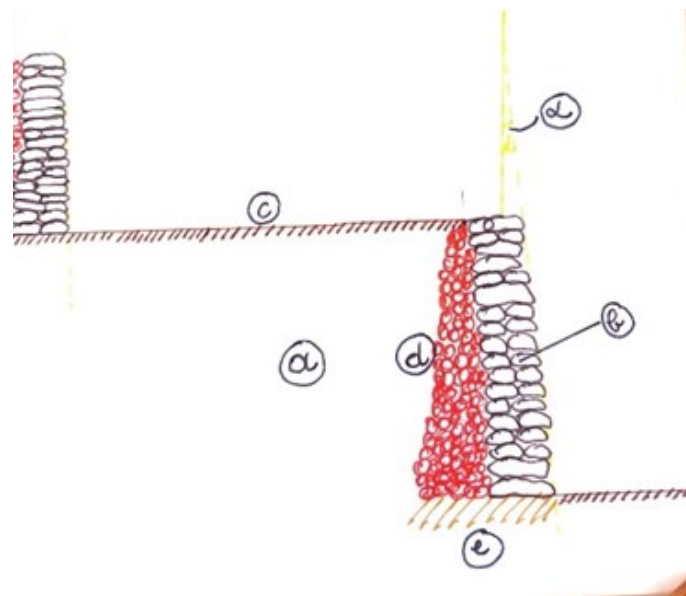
Nomenclatura del terrazzamento: (a) terrapieno; (b) muro a secco; (c) lenza o ripiano o pianale; (d) contromuro; (e) fondazione; (α) contropendenza. (Immagine autore)
